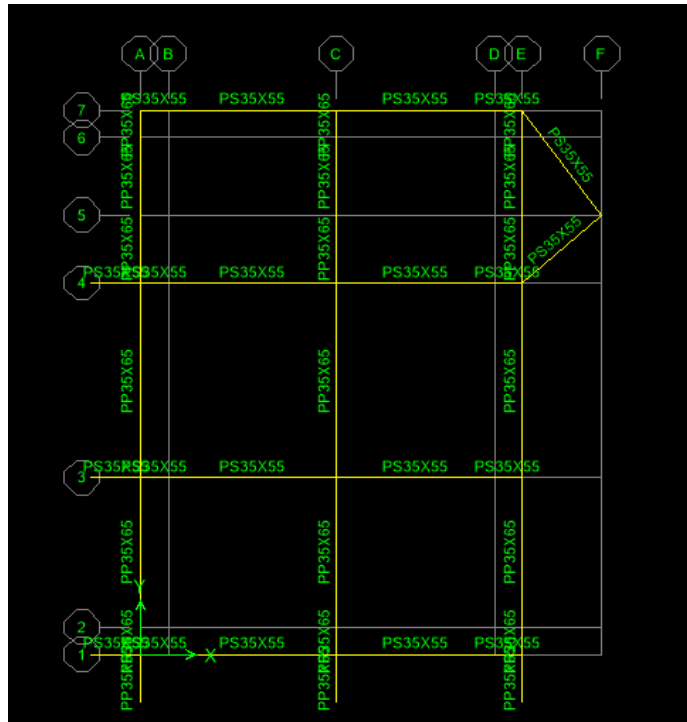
Plan de repérage des poutres et des chainages (B1).
